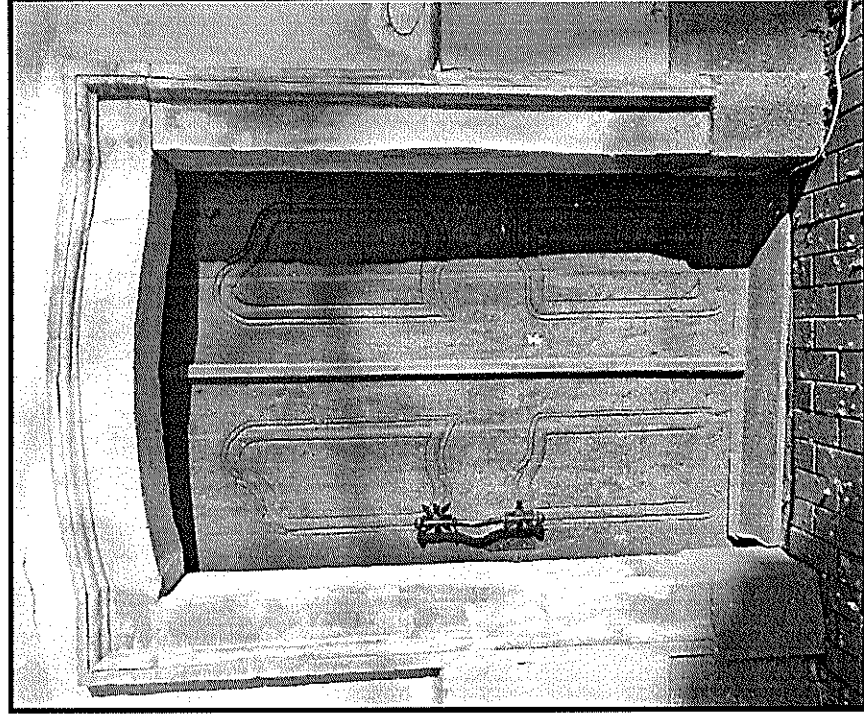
Stan zachowania elewacji frontowej (zachodniej) kościoła w Regnowice.
